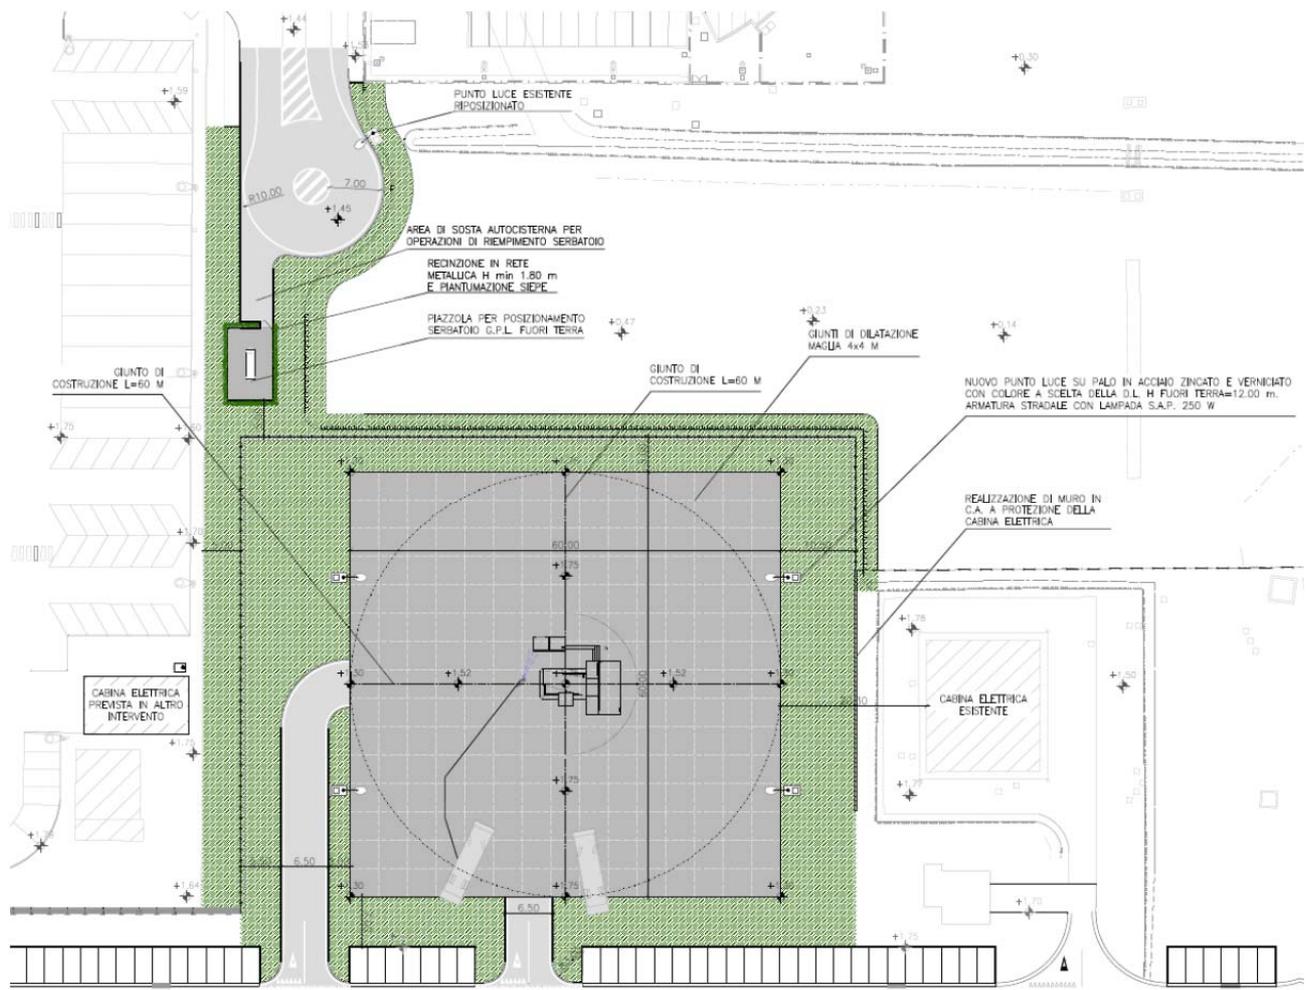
Campo prove VVF (codice 2.20) - Planimetria dell'intervento.
